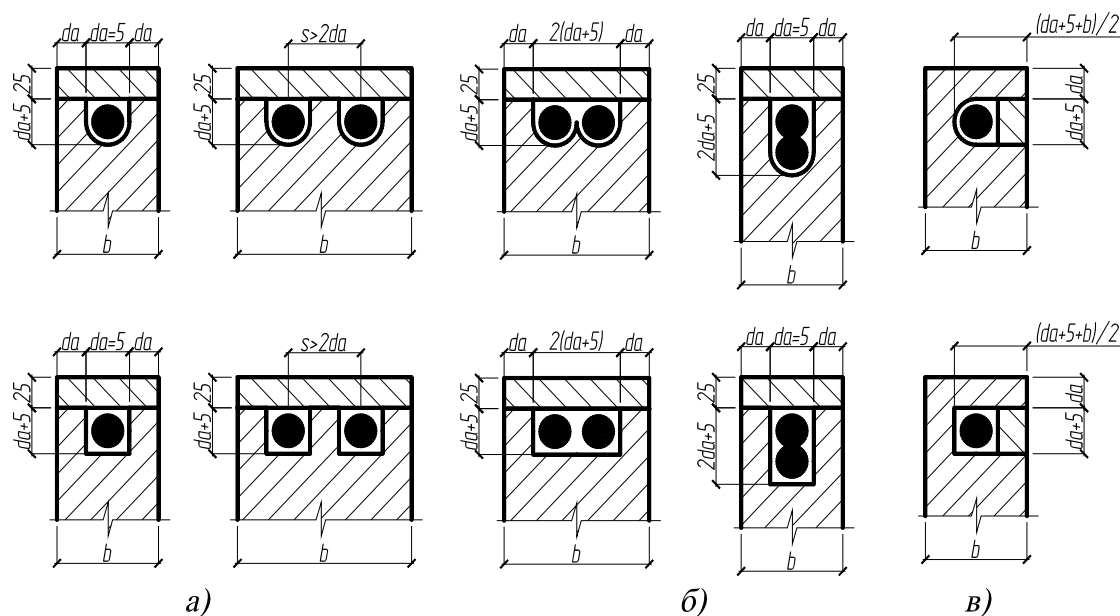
Размещение пазов полукруглого и прямоугольного очертания по ширине сечения: а – обычным способом; б – групповым способом; в – при вклеивании стержня по боковой поверхности
